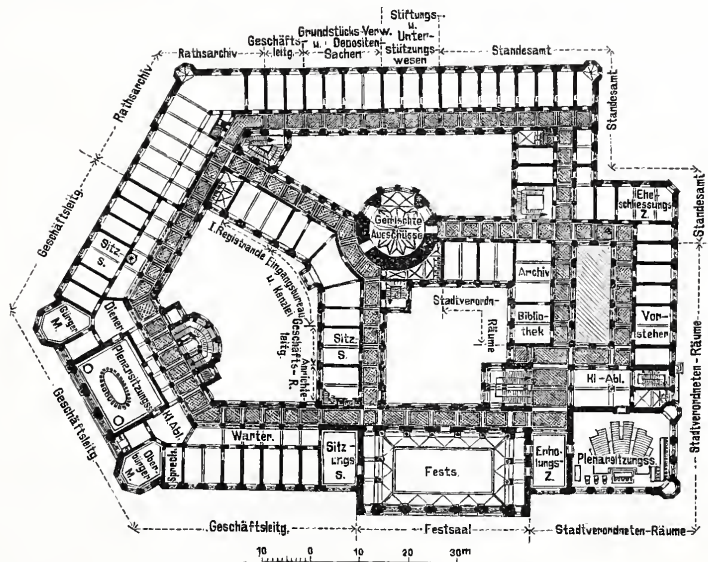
Grundriss vom Hauptgeschoß.
